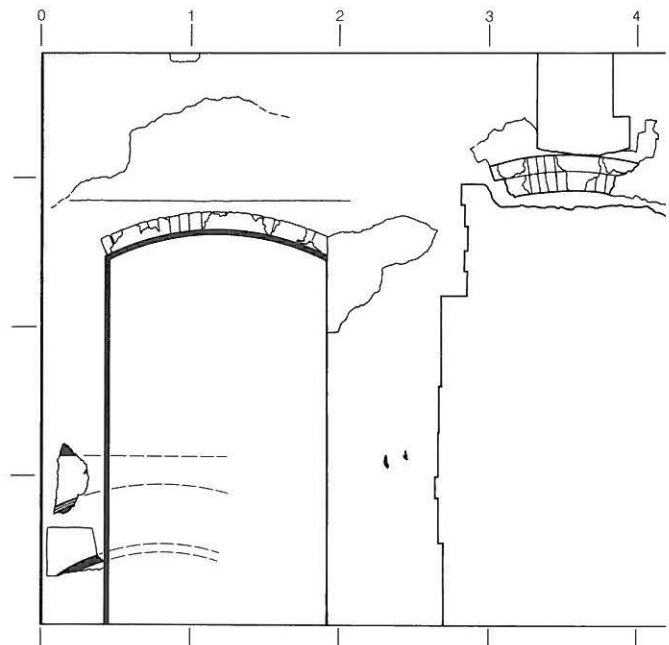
Bern, Erlacherhof. Detailplan mit Portalfund. M. 1:50.
